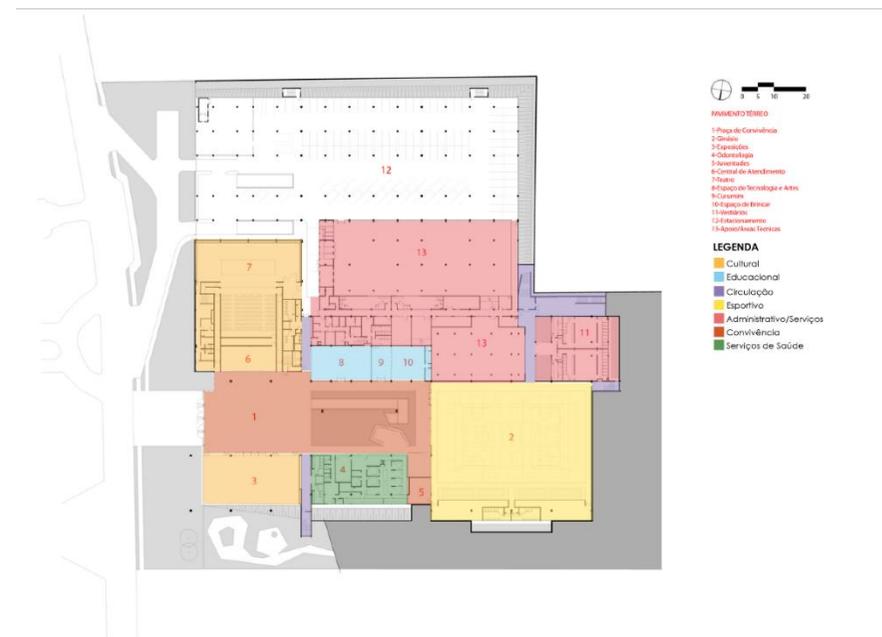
Planta Baixa SESC Guarulhos - Pav. Térreo: estudo usos e zoneamento.
